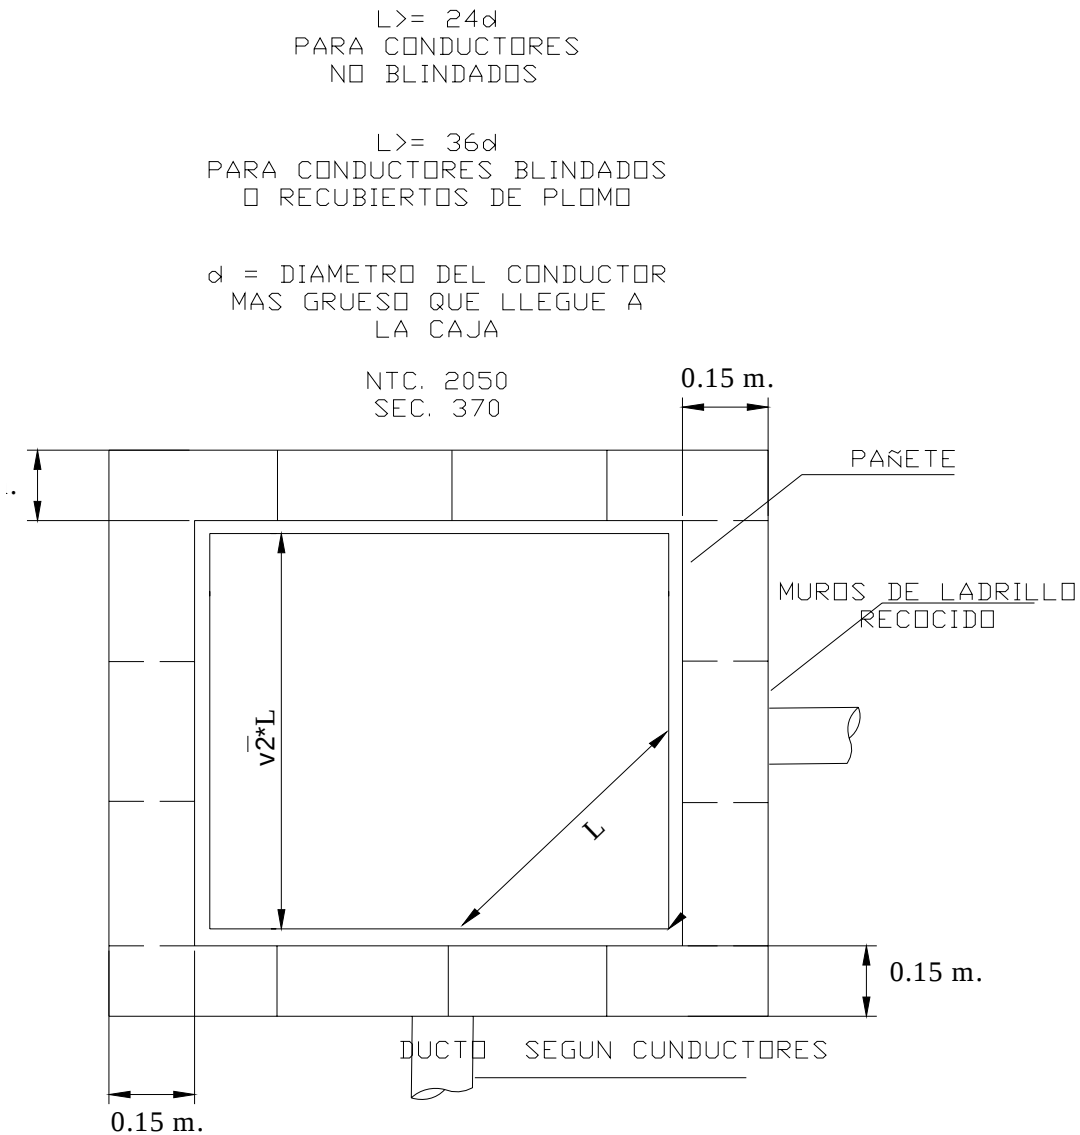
Caja de inspección en MT. Vista planta para tendidos en U o L.
